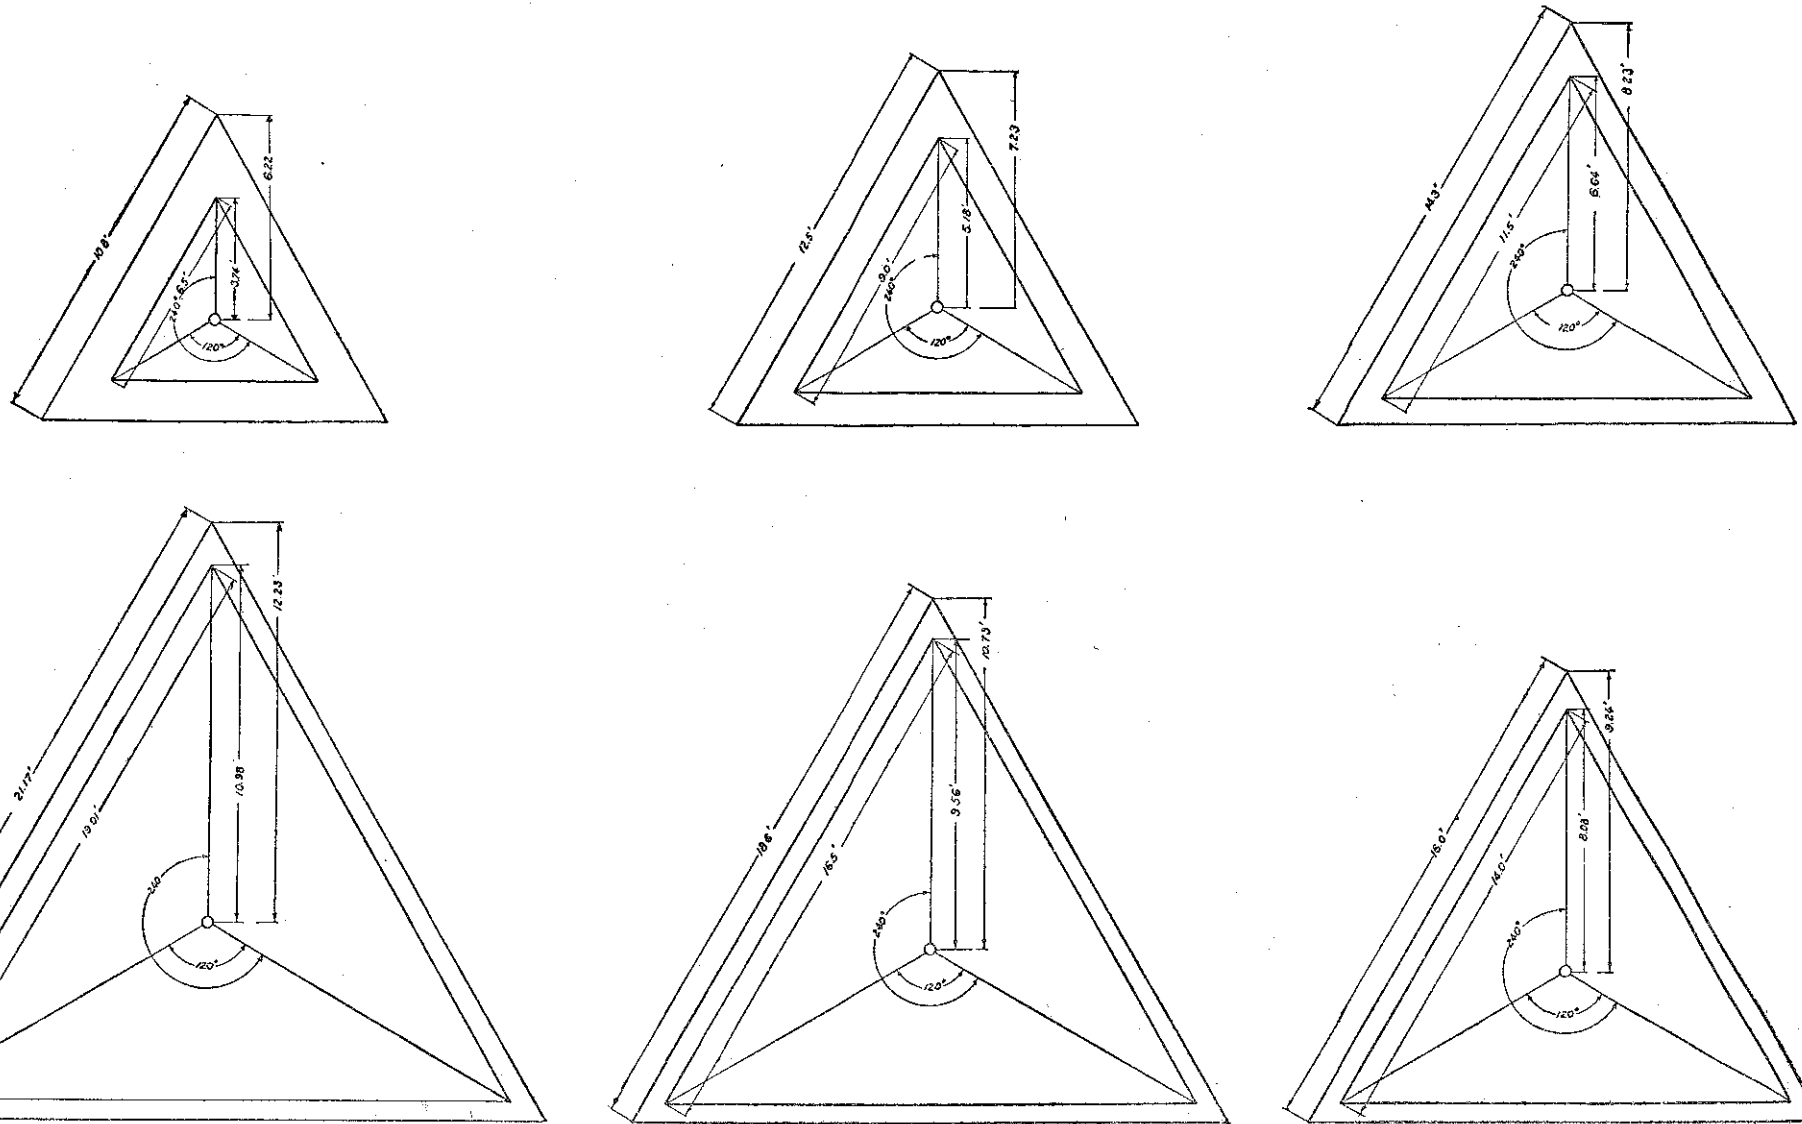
Plantas de Torres Bilby de acero de 37, 50, 64, 77, 90 y 103 pies.
